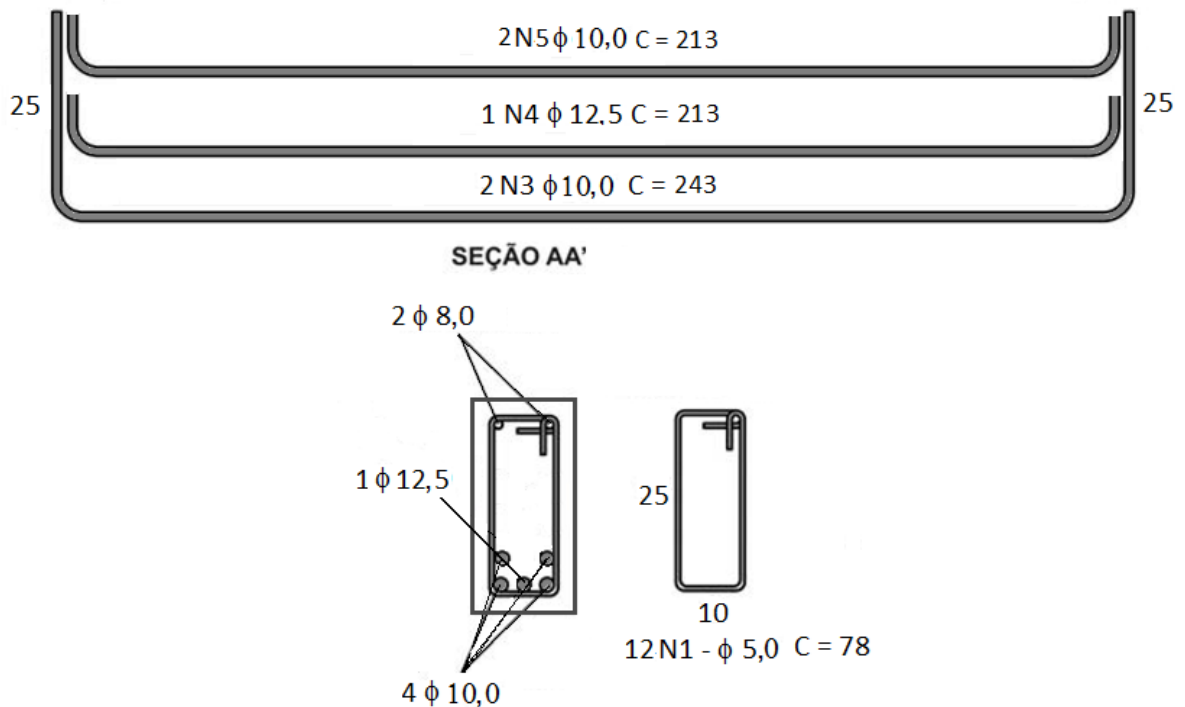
Armaduras das vigas do Tipo 1 (dimensões em centímetros, exceto diâmetros que estão em milímetros).
